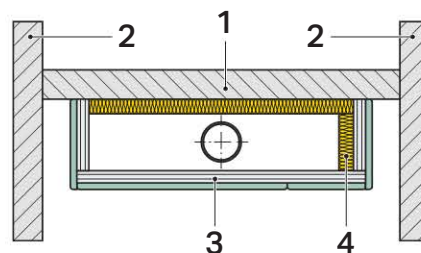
Grundriss, Leitungen in Schacht verlegt
